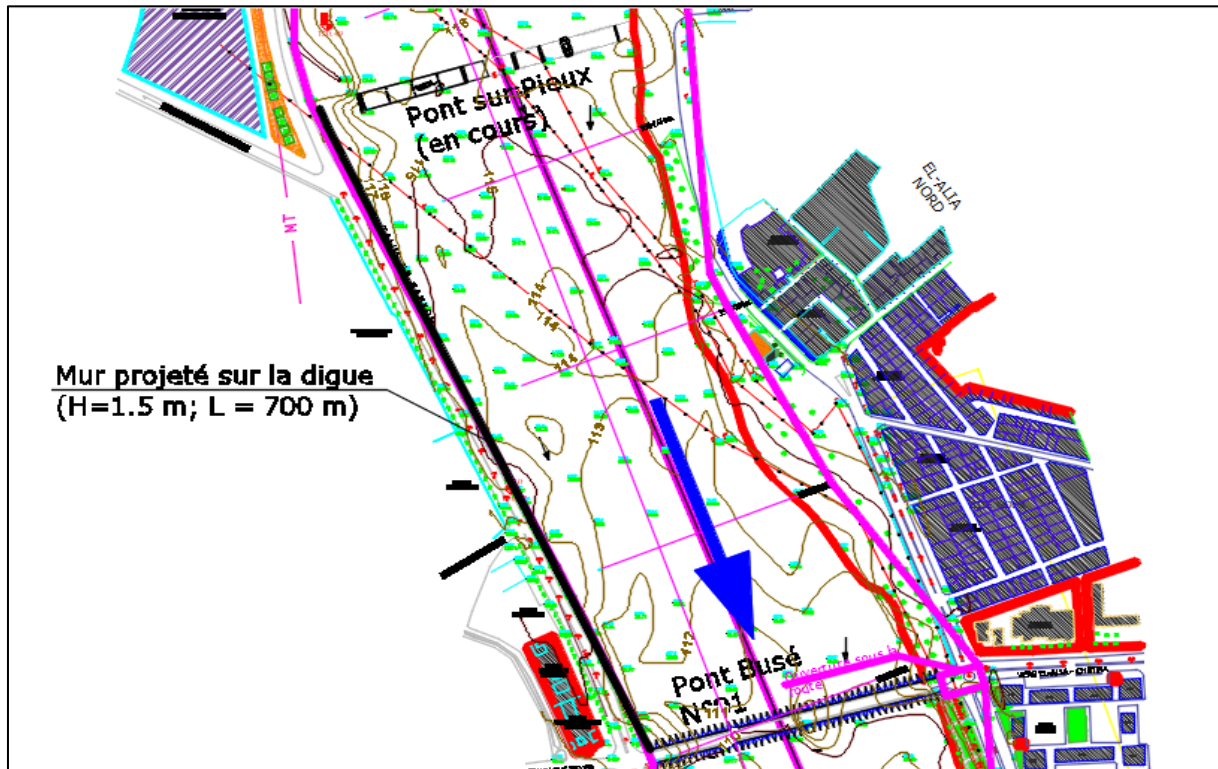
Vue en plan du mur projeté en amont du premier pont busé.
